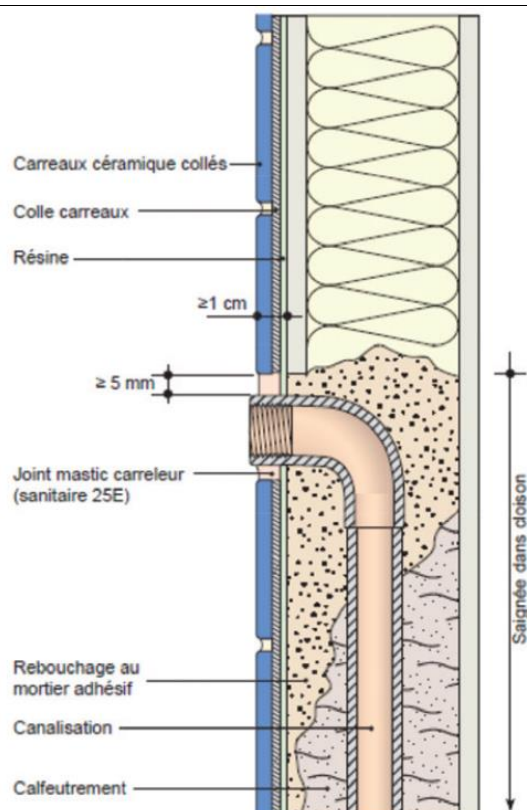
Traitement d'une canalisation encastrée (sans fourreau) en paroi verticale ; exemple d'une cloison en plaques de parement en plâtre.
